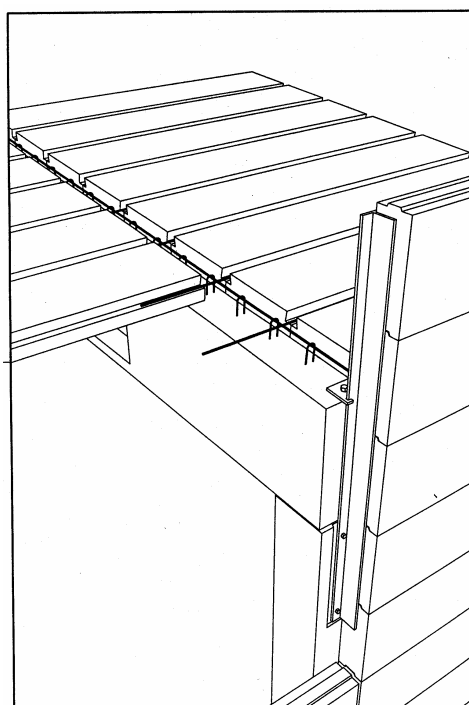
exemplo de um diafragma de cobertura com lajes de concreto ou elementos de concreto celular. A armadura de tirante nas juntas é interligada com as barras projetadas (barras de espera) das vigas de cobertura.
